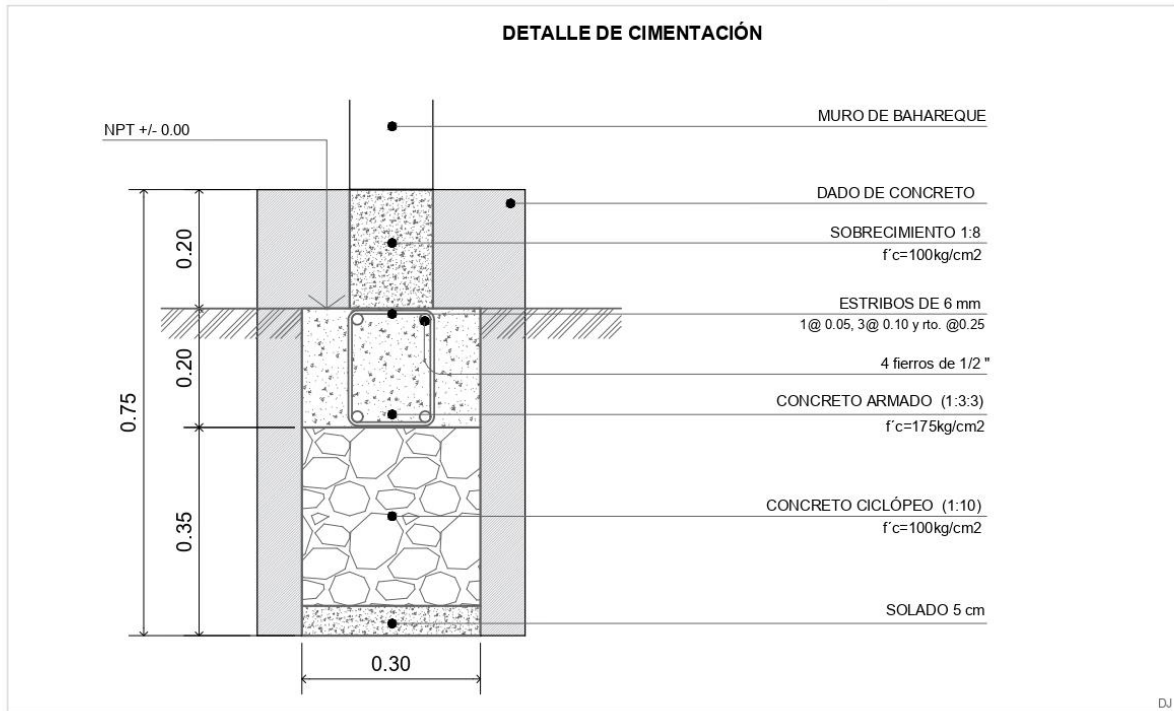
Detalle constructivo de cimentación. Fuente: El autor
